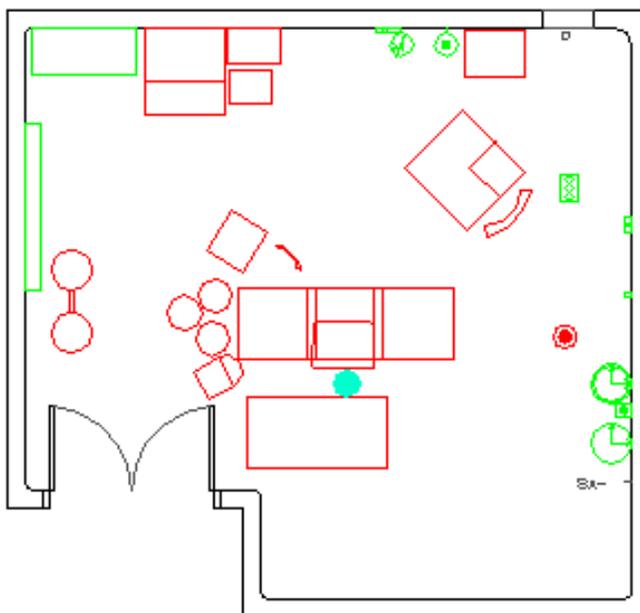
Plano de ubicación de la enfermera instrumentista en la posición 1
